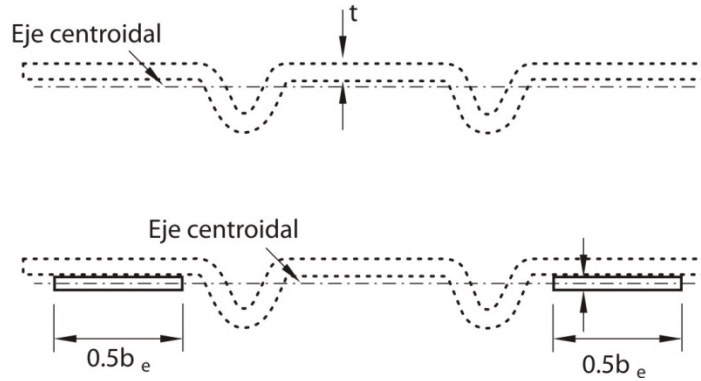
Localizaciones de anchos efectivos
